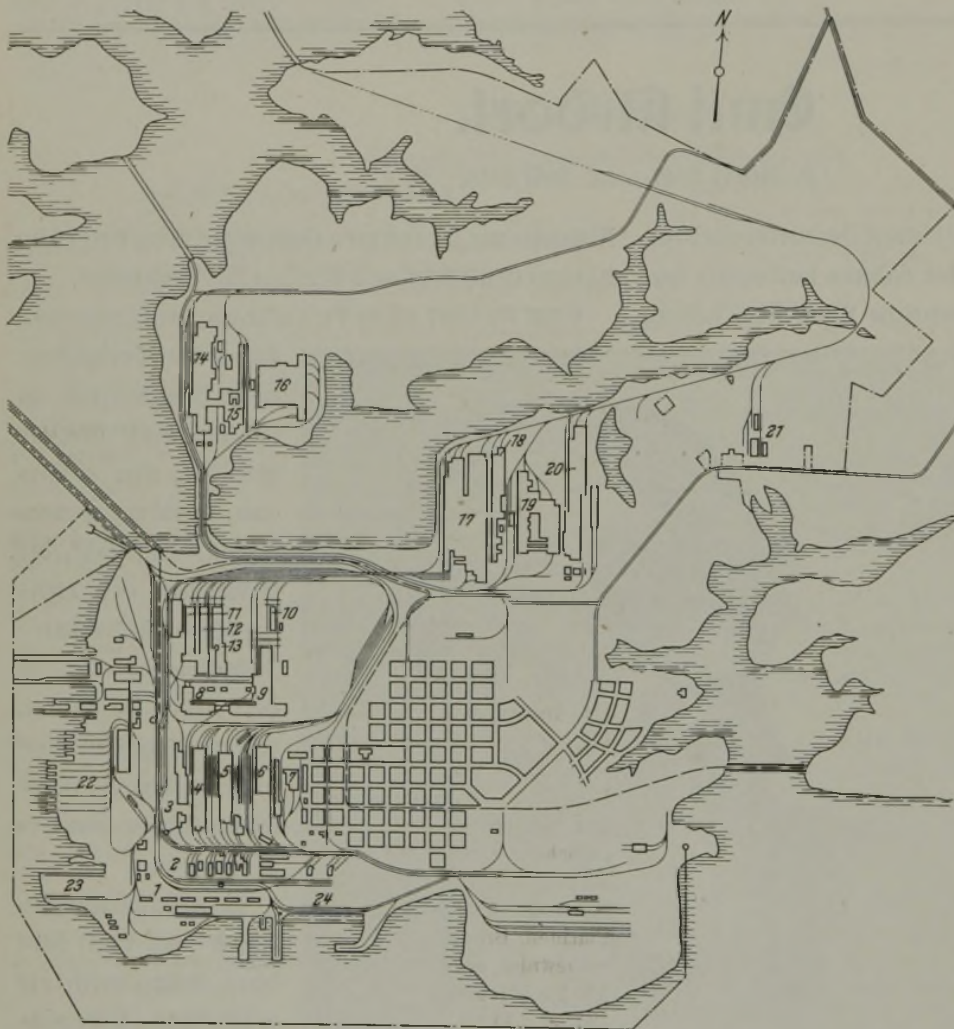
Lageplan der Maryland-Werke der Bethlehem Steel Co. in Sparrows Point.
